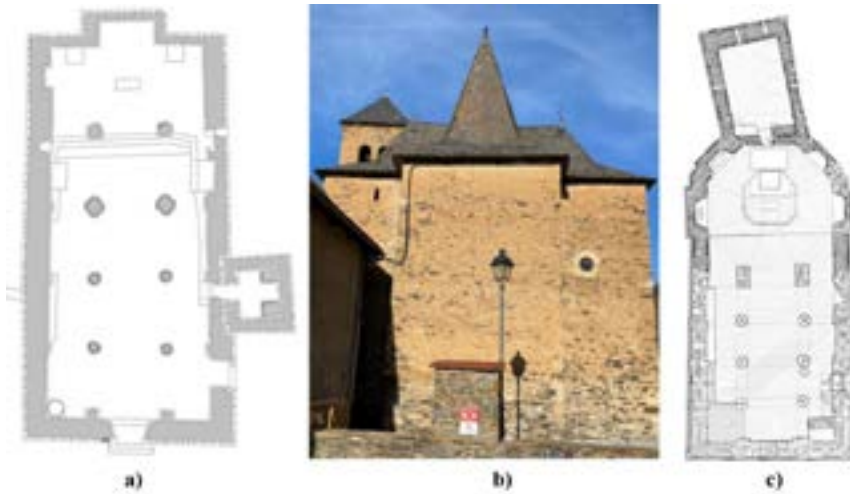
a) Planta de Sant Fèlix de Vilac [24]; b) Absida de Santa Maria de Vilamòs [12]; c) Planta Santa Maria de Vilamòs [12]
